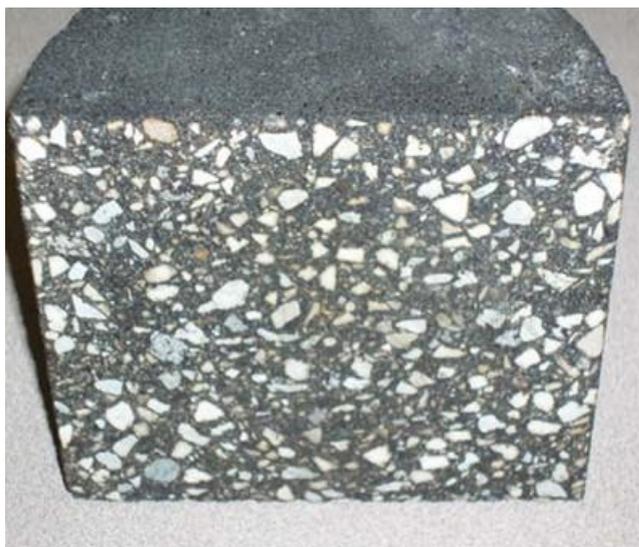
Núcleo tomado de un bloque de prueba en el sitio de la construcción.
